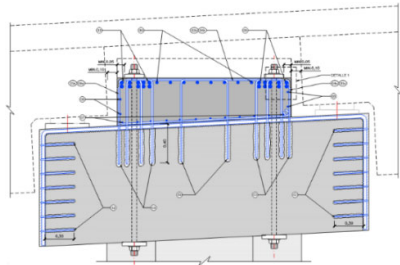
Refuerzo de la cabeza de pila para permitir el apoyo del lanzador de vigas
